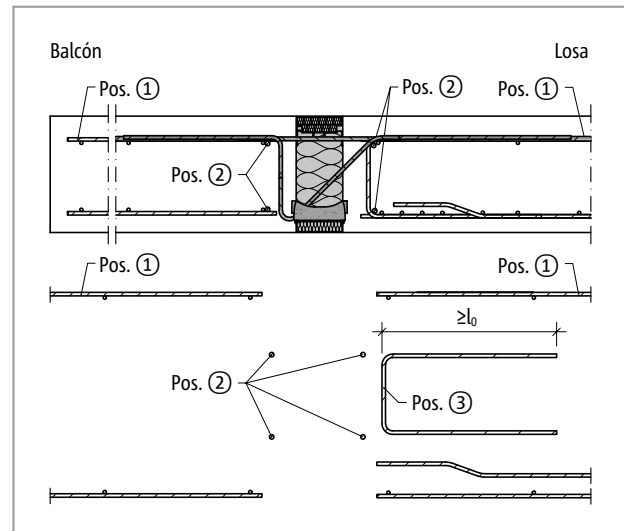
Schöck Isokorb® T tipo K-M1 hasta M11: Armadura in situ en caso de apoyo indirecto
